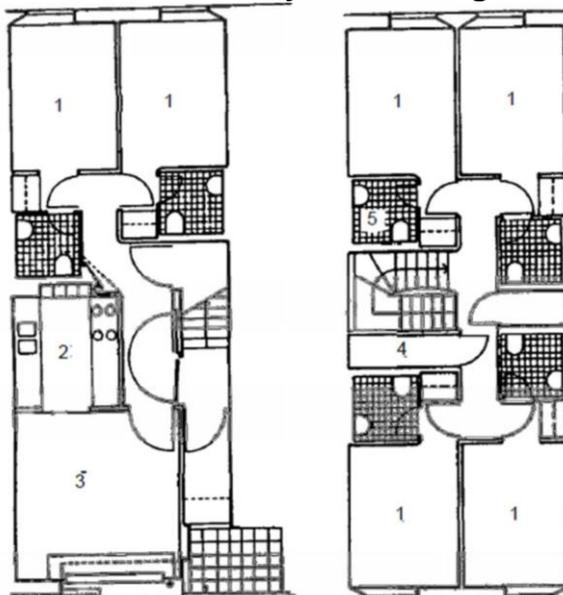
Planta do pavimento tipo. Alliance Student Housing em Newington Green, Londres
